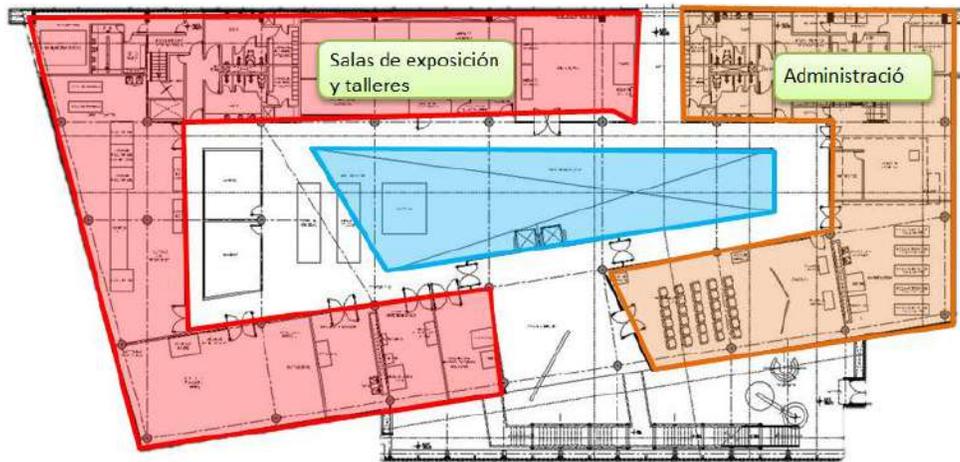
Funcionalidad 1ra planta (Instituto Monterrey)
